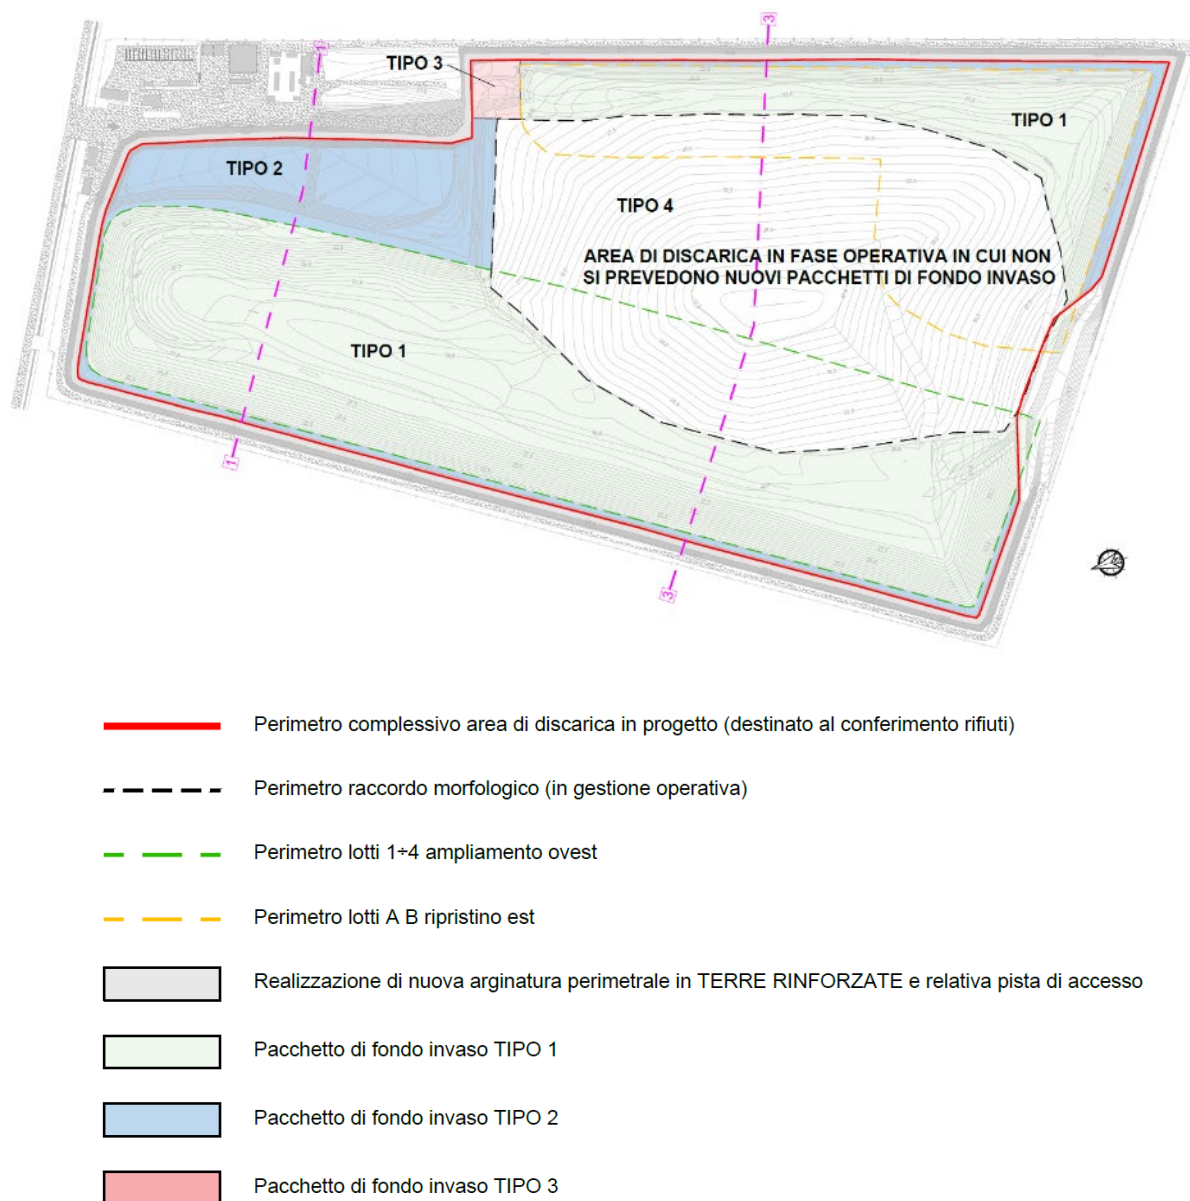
Pacchetto di fondo [stralcio tavola 3.8 del progetto]
